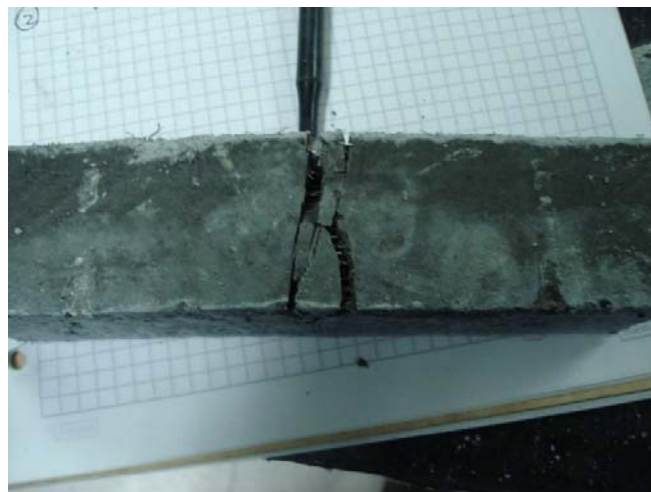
Vista inferior de la fisura de la viga ensayada a flexión.
